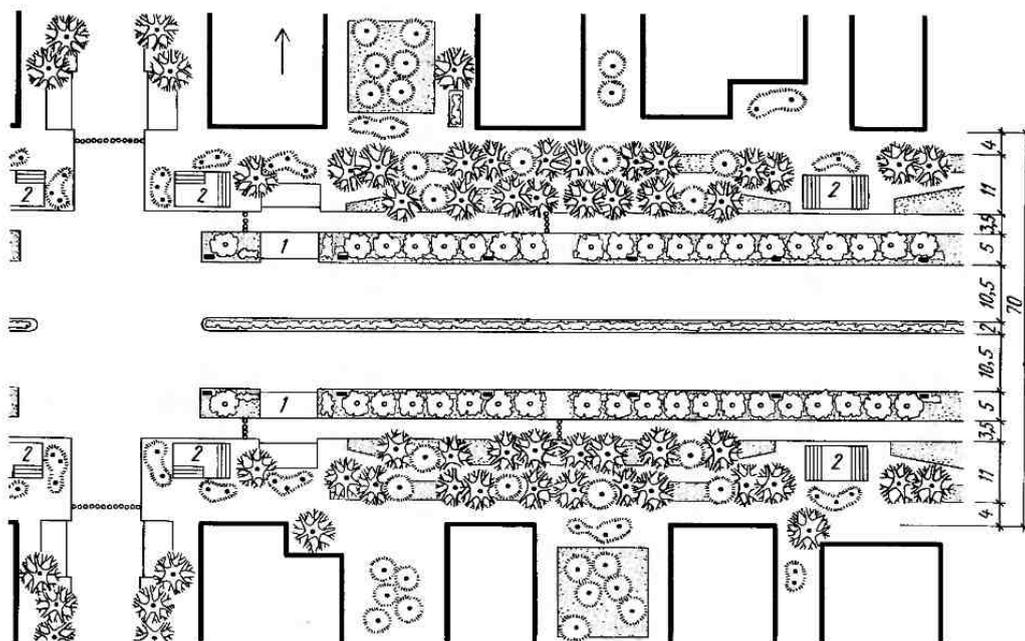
Фрагмент плана улицы с шумозащитными насаждениями:
